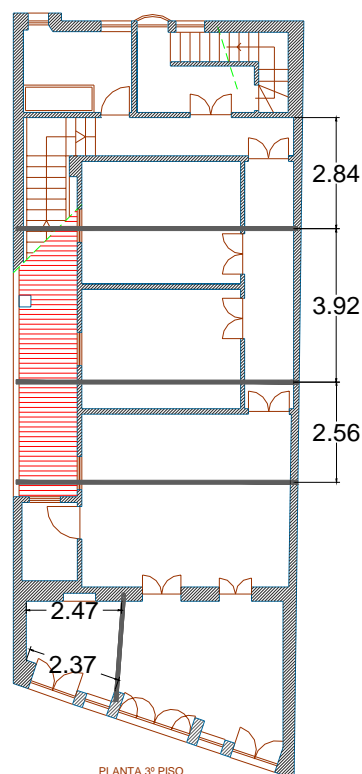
Localização dos perfis metálicos no pavimento do 3º piso
